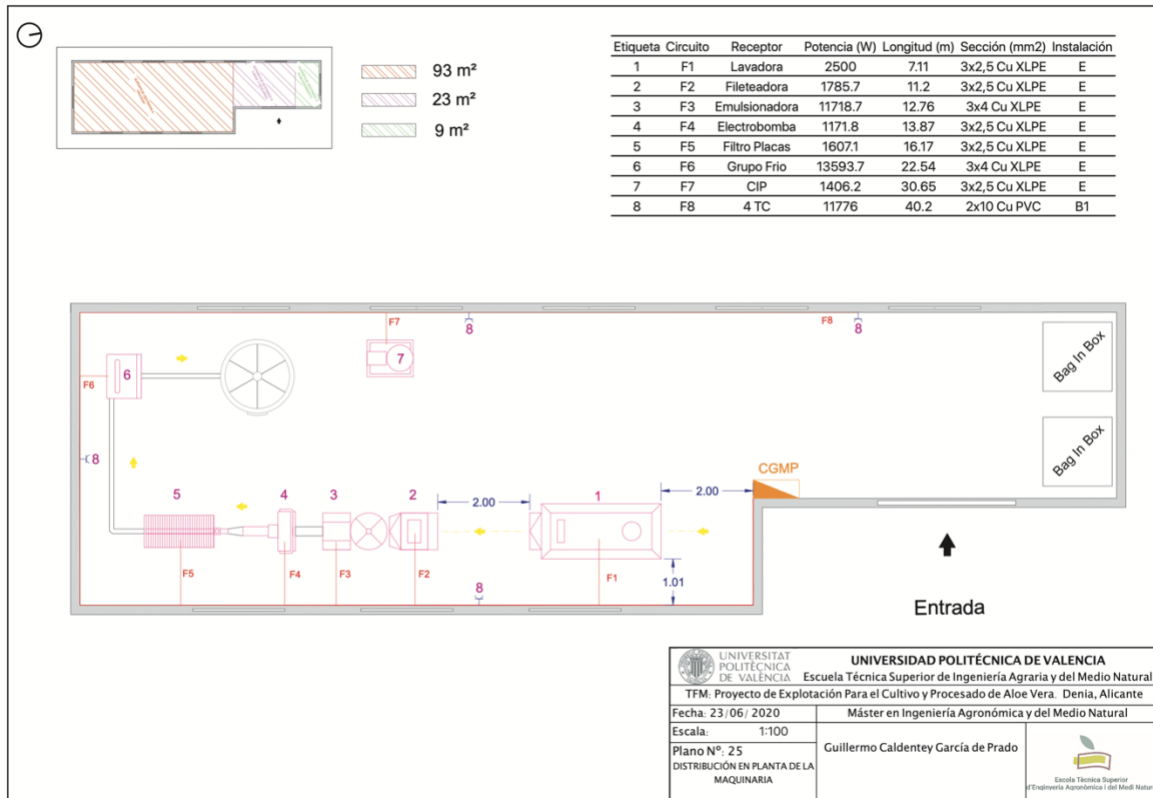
Plano 25. Distribución en Planta de la Maquinaria
